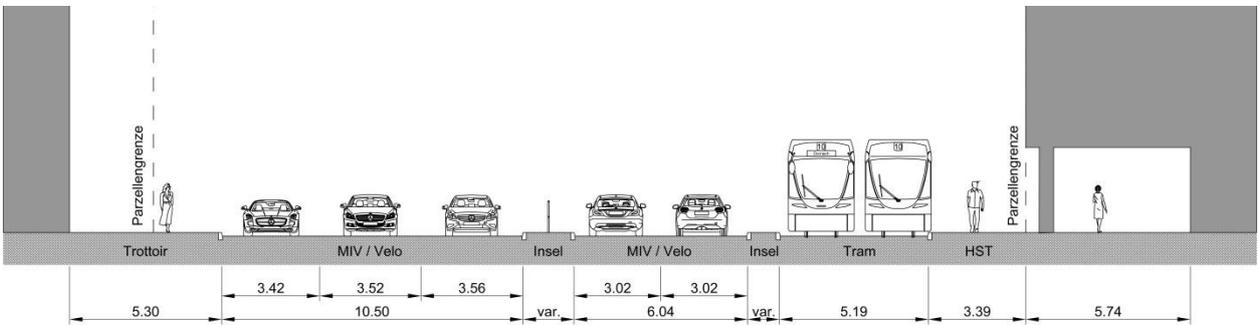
Querprofil B-B im Abschnitt Brüglingerstrasse bis Walkeweg (Bestand)
